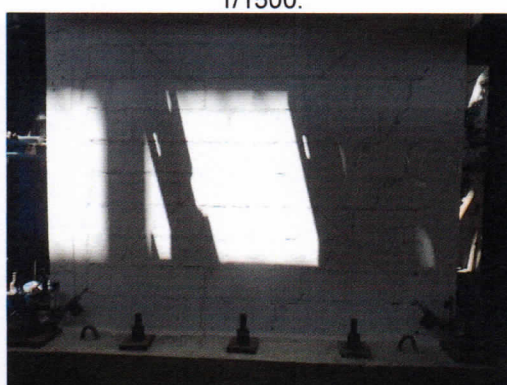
Formación de grietas diagonales en el mortero y primera grieta en ladrillo en la parte superior Este y Oeste de la cara Norte para una distorsión 1/1500.
